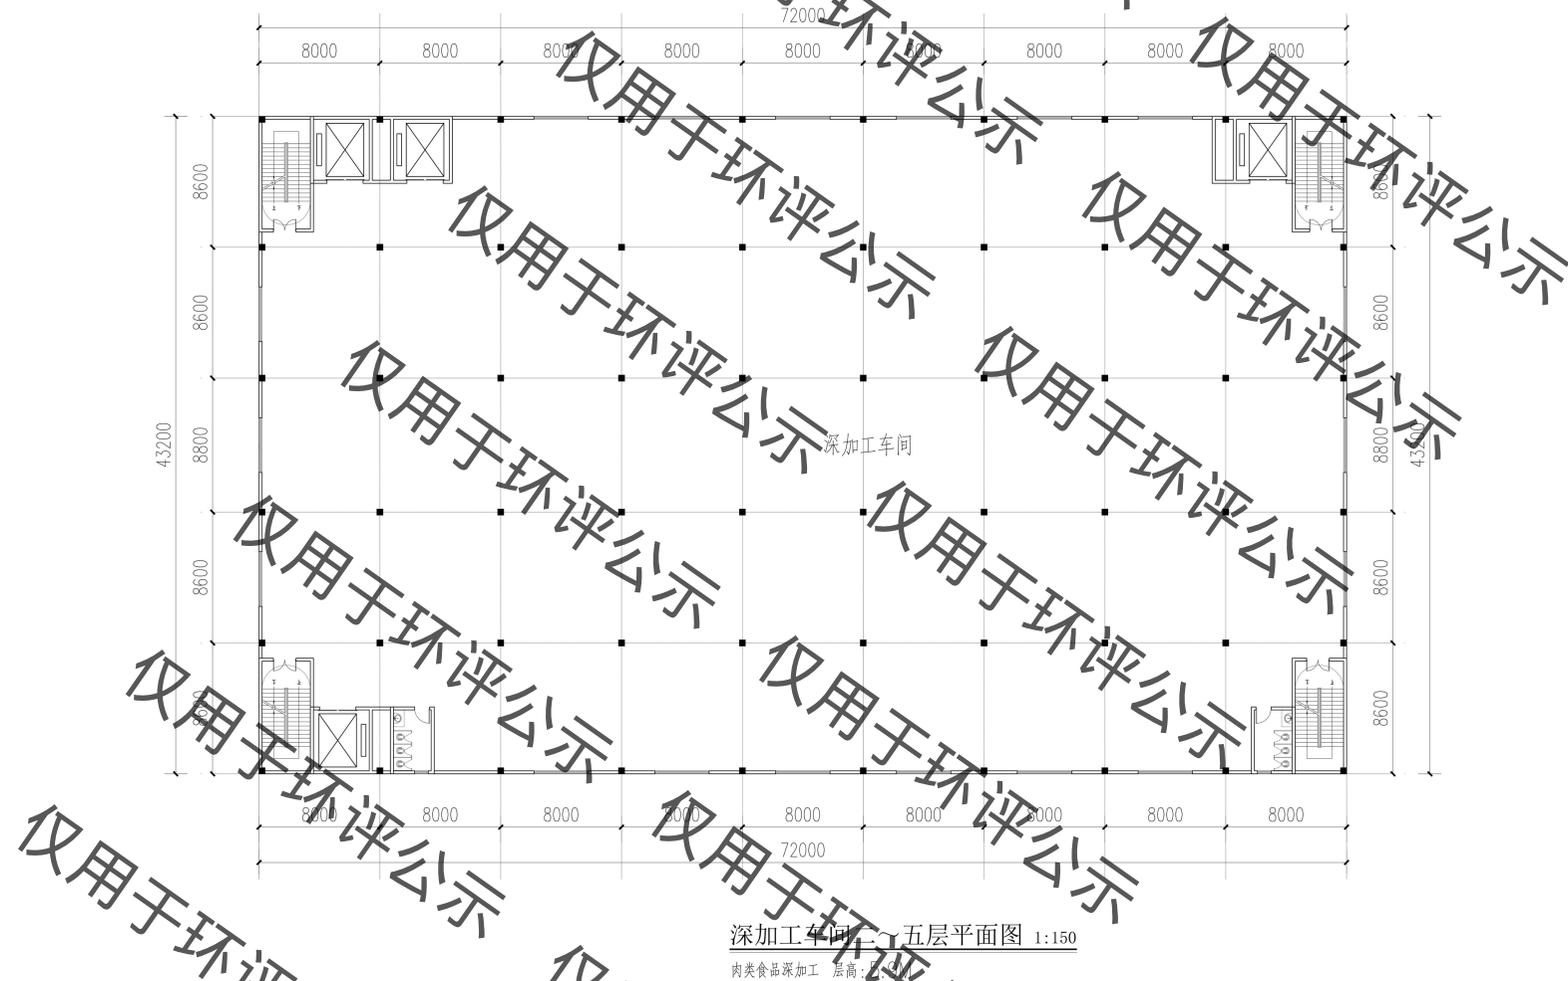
肉类加工车间平面布置图(2~5层)
